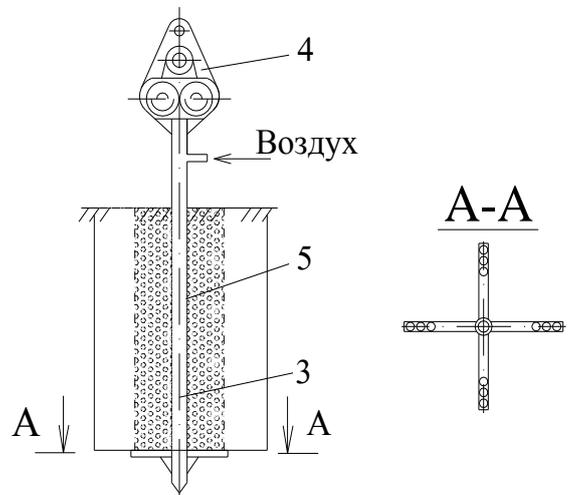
Пояснительные схемы к изоляции грунтового массива путем аэрирования грунта:
